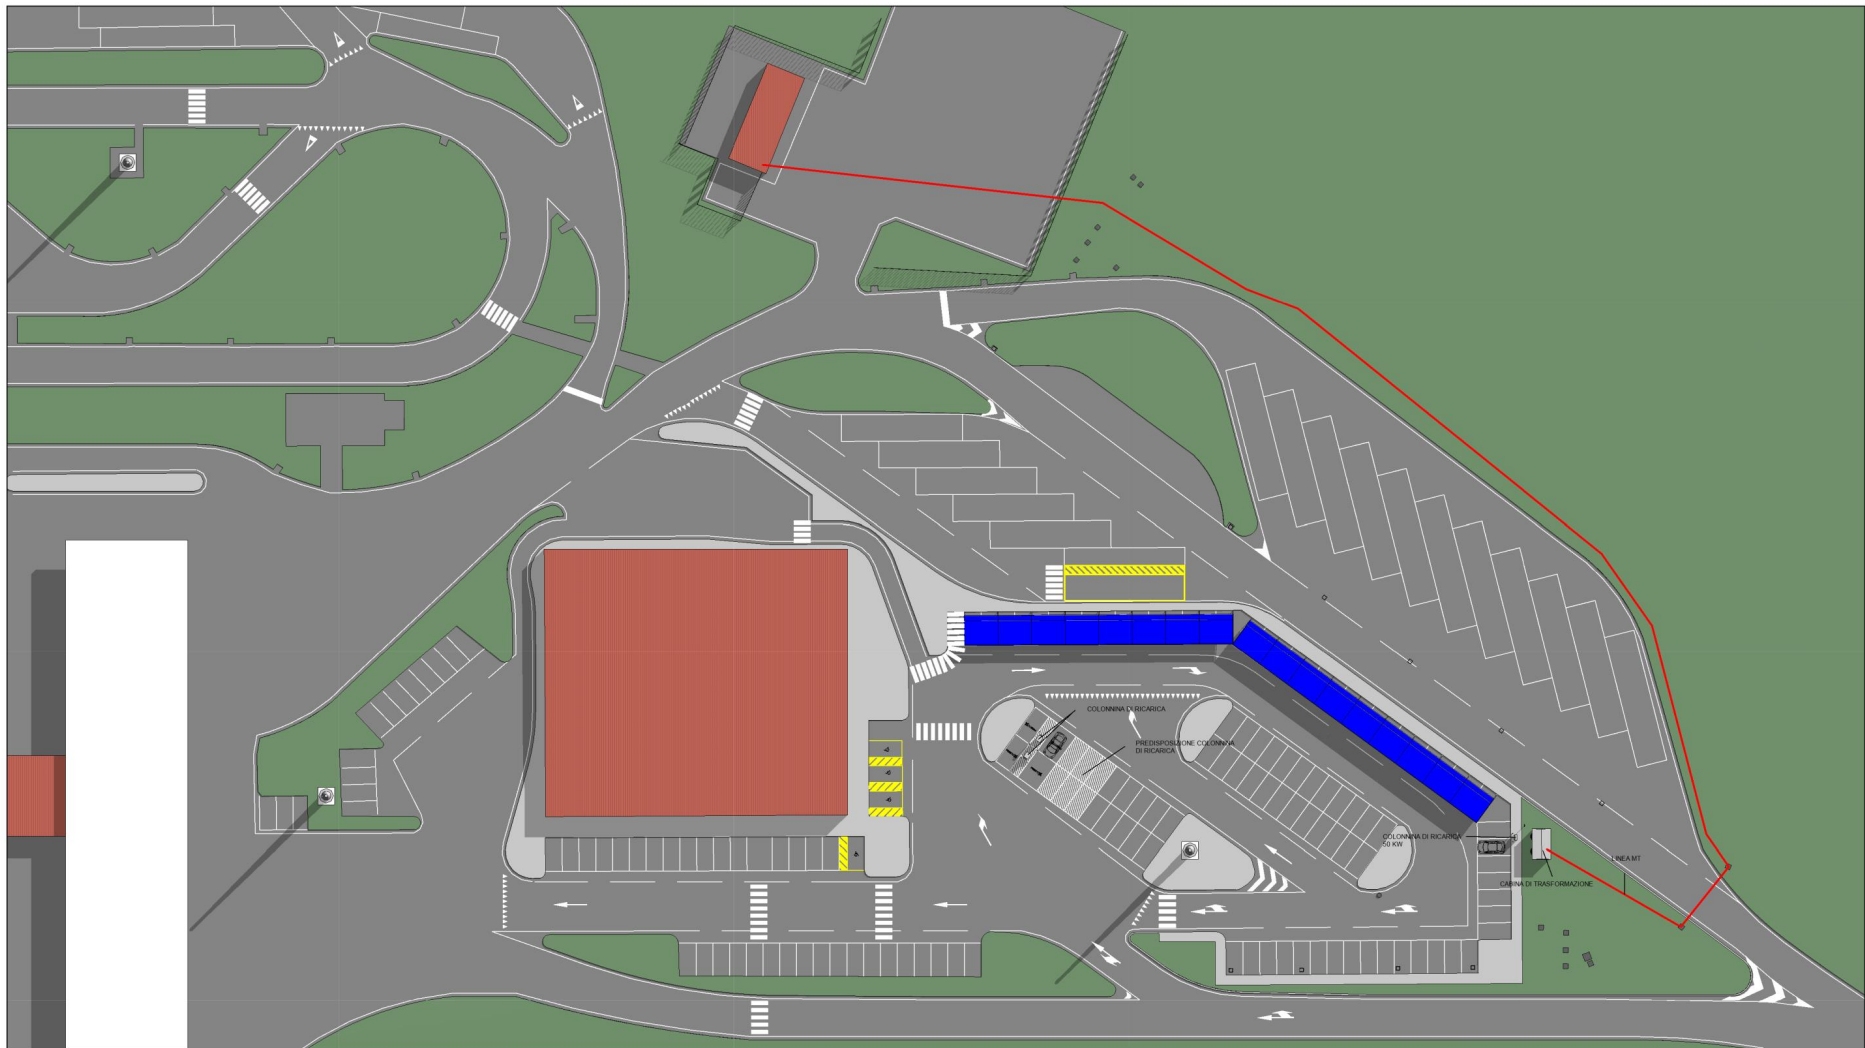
Area di Servizio La Pioppa ovest - Planimetria
